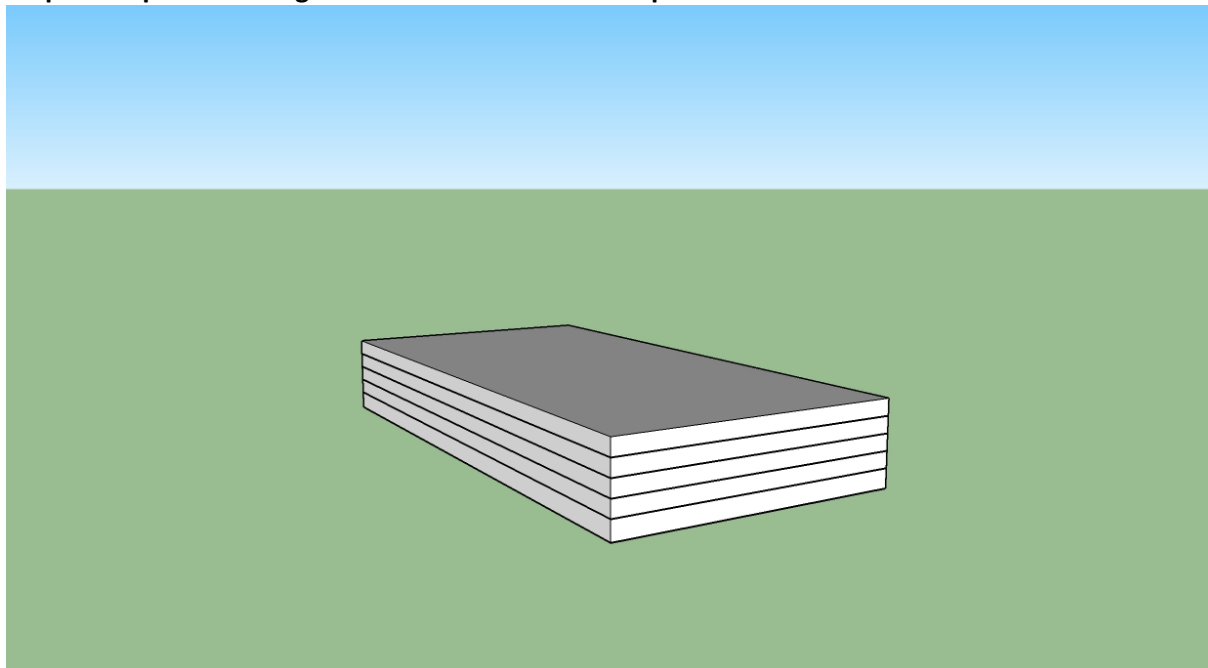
Plan Looping Towers gezien vanaf Safariweg (kijkend richting zuiden/winkelcentrum)
